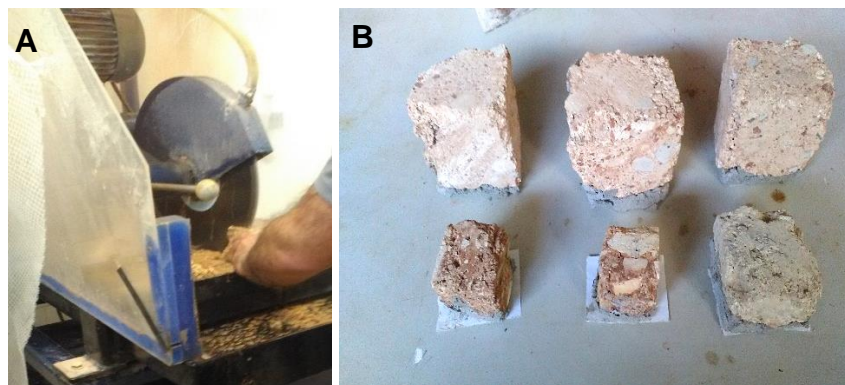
Preparação dos provetes para o ensaio de compressão: A – corte; B - aplicação de argamassa para regularizar a base
